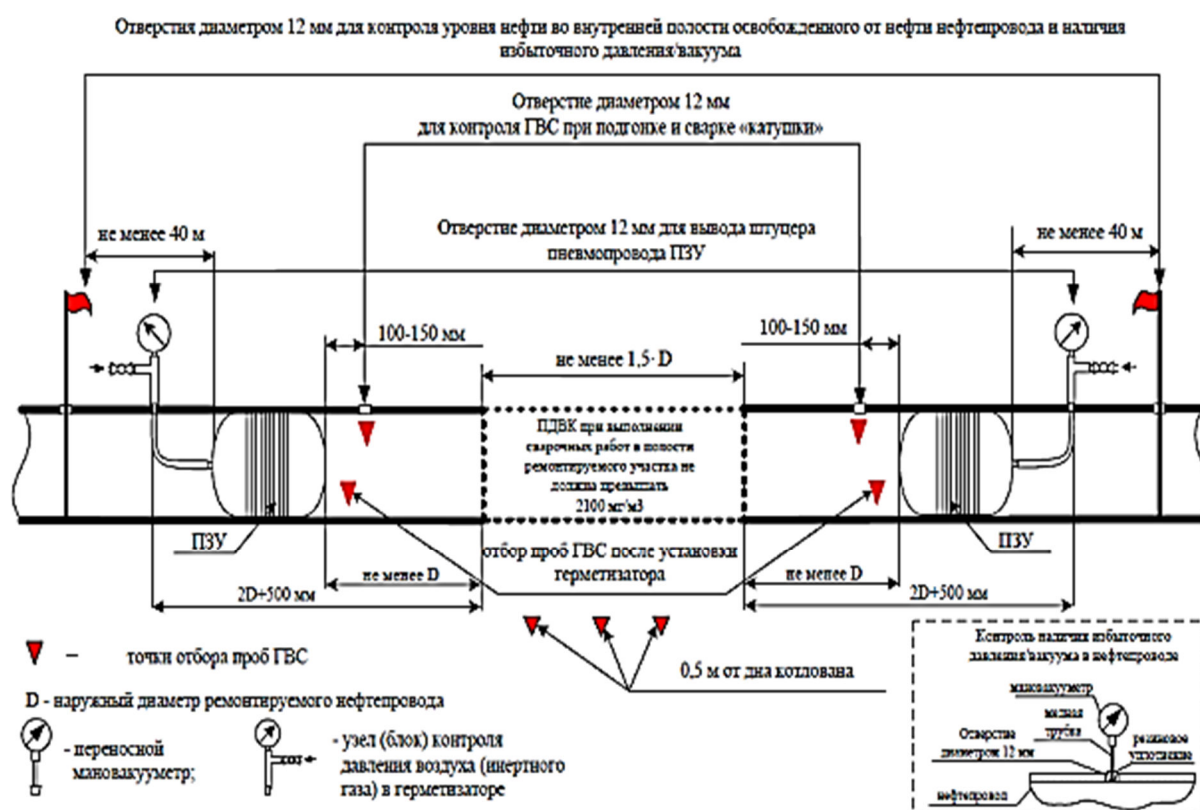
Схема установки герметизаторов ПЗУ и расположения отверстий для отбора проб ГВС, контроля уровня нефти/нефтепродукта во внутренней полости МТ и наличия избыточного давления/вакуума
